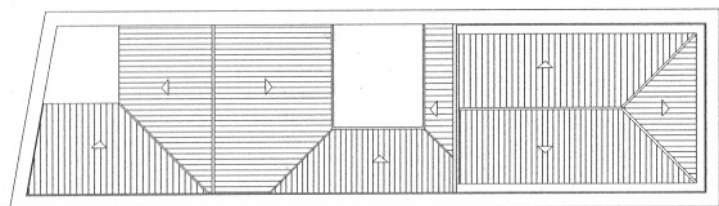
Cortiço na rua Sacadura Cabral, 295 – Cobertura (SECRETARIA, 2000, p. 24).
